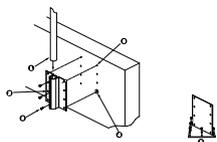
Placa de suporte para montagem no telhado e suporte de montagem mural em parapeito
